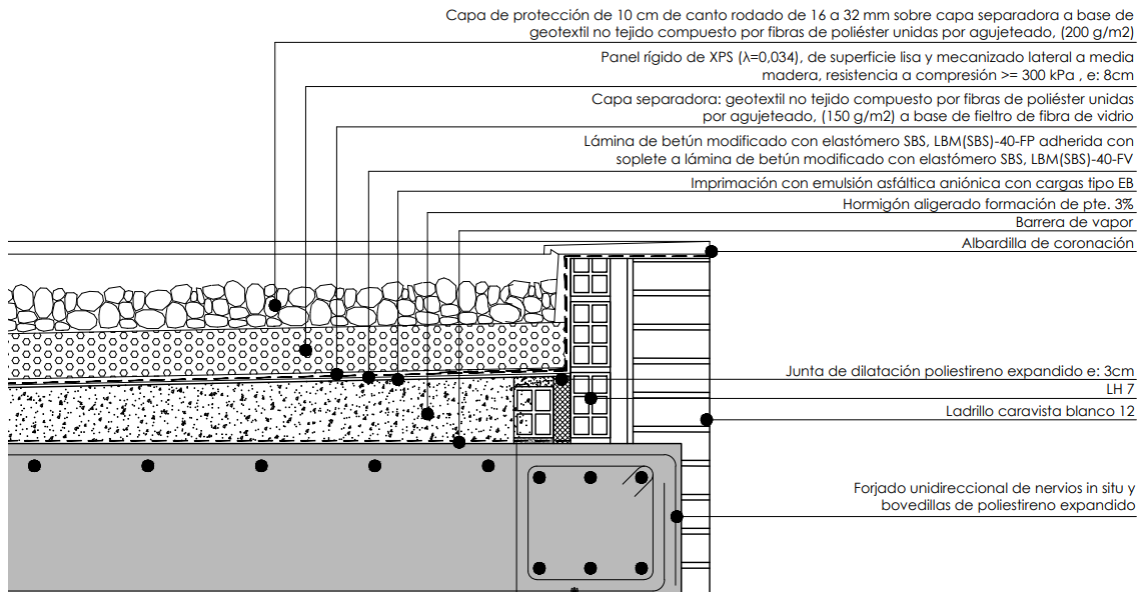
Detalle de cubierta no transitible (encuentro con el peto).
